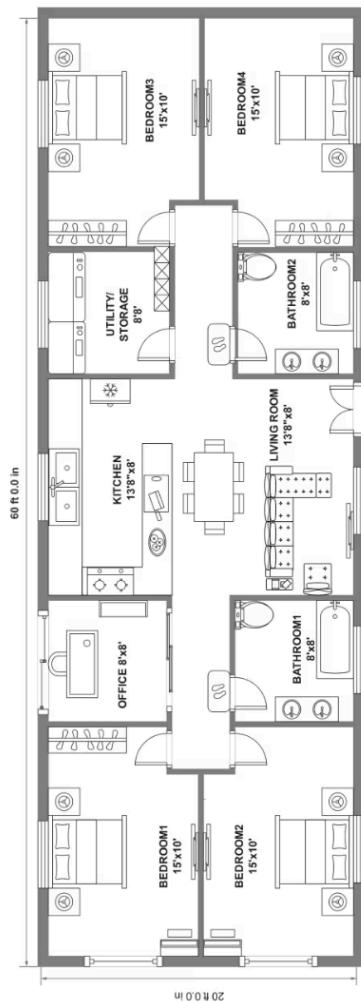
Verwendeter Grundrissplan *Hospital\_Floor\_Plan.pdf
